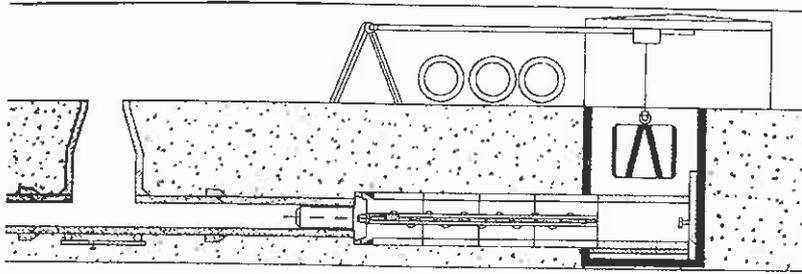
Prinzipskizze Erneuerungsverfahren mit Rohrauswechslung durch Pipe Eating (Quelle: ÖWAV RB28)
